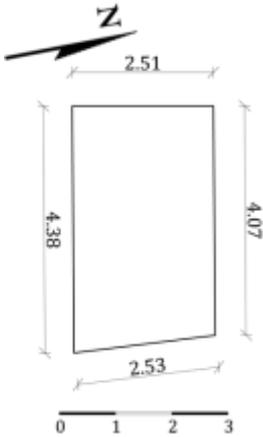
مسقط أفقي للمنور بدهليز المدخل بمدرسة بيبرس الخياط (عمل الباحثة)
